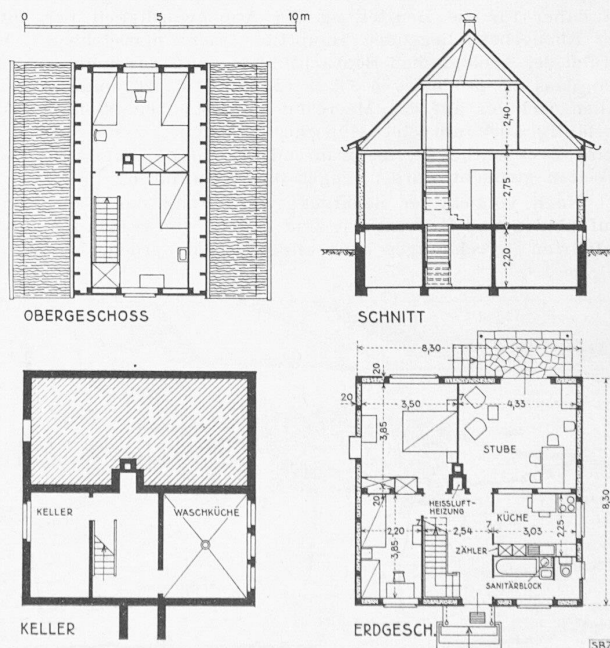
Grundrisse und Schnitt eines Einfamilienhauses, 1:250
